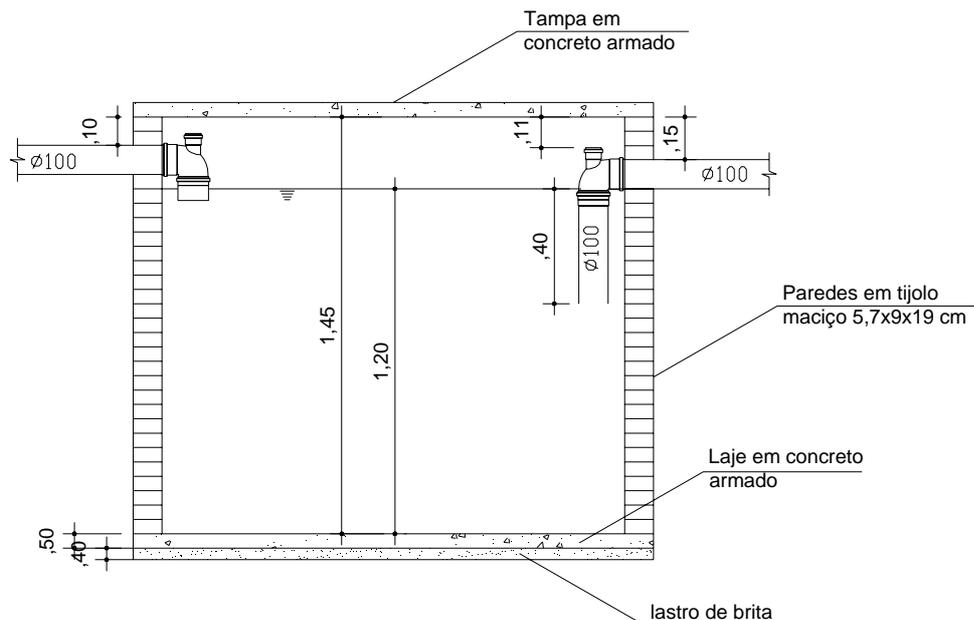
Corte AA do tanque séptico prismático. Dimensões em metros (m).
